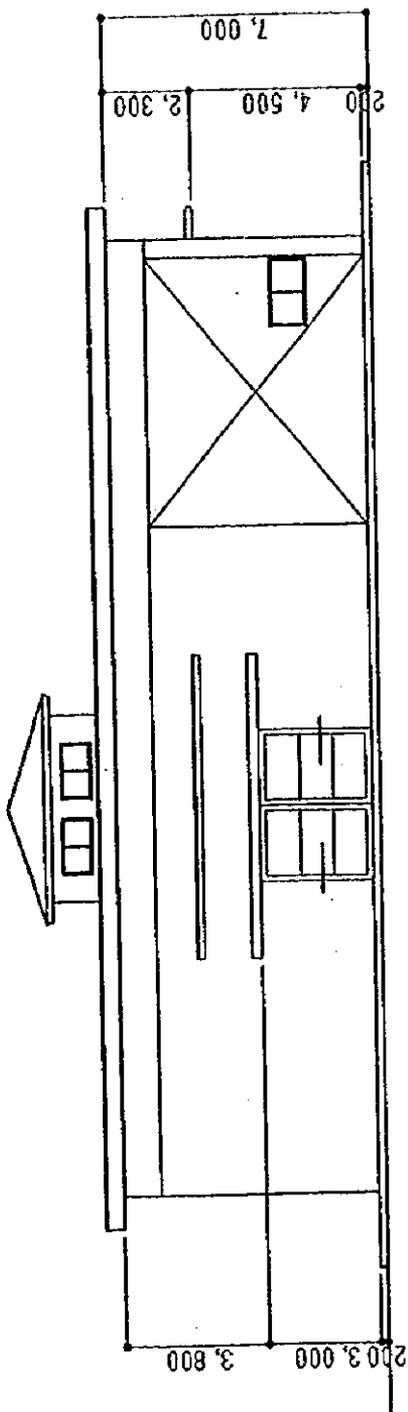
(11) Plan de face et la coupe de l'embarcadere.
